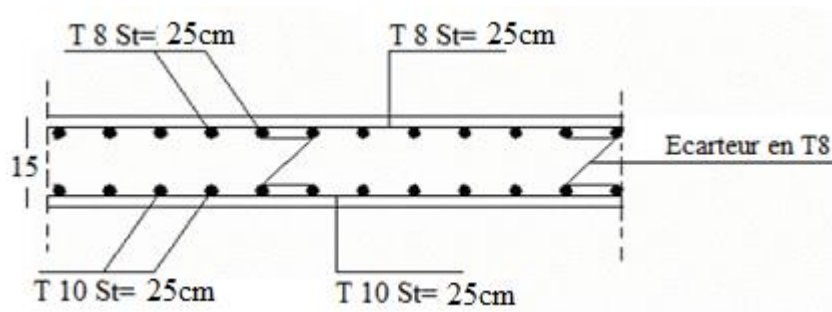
Ferrailage de la dalle pleine rectangulaire.
